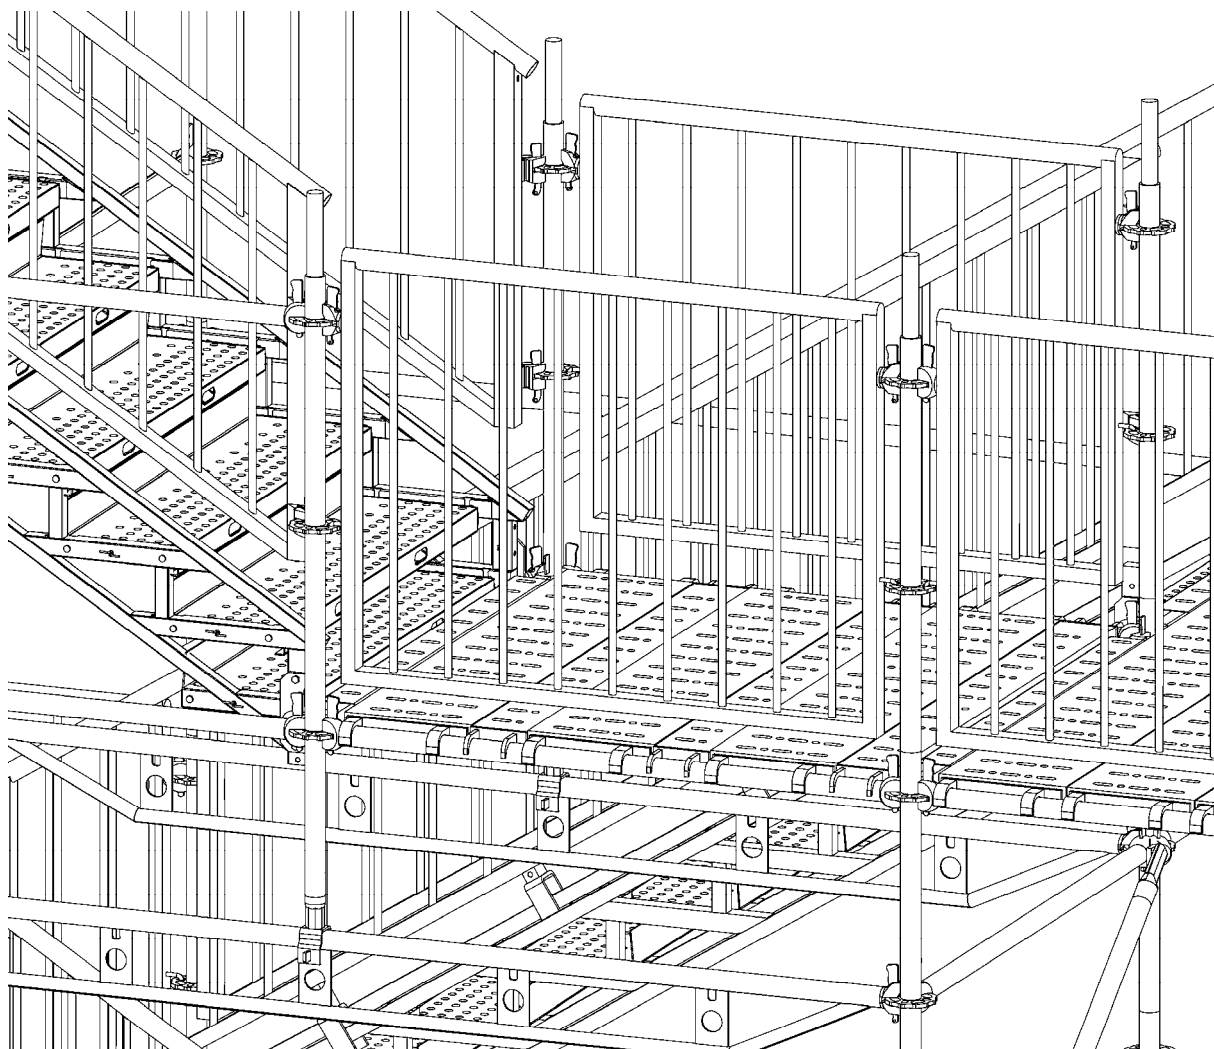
Detail Zwischenpodest bei 11-Stufen Treppentürmen mit Laufbreiten von 1,25 m und Belägen für Rundrohrauflage
